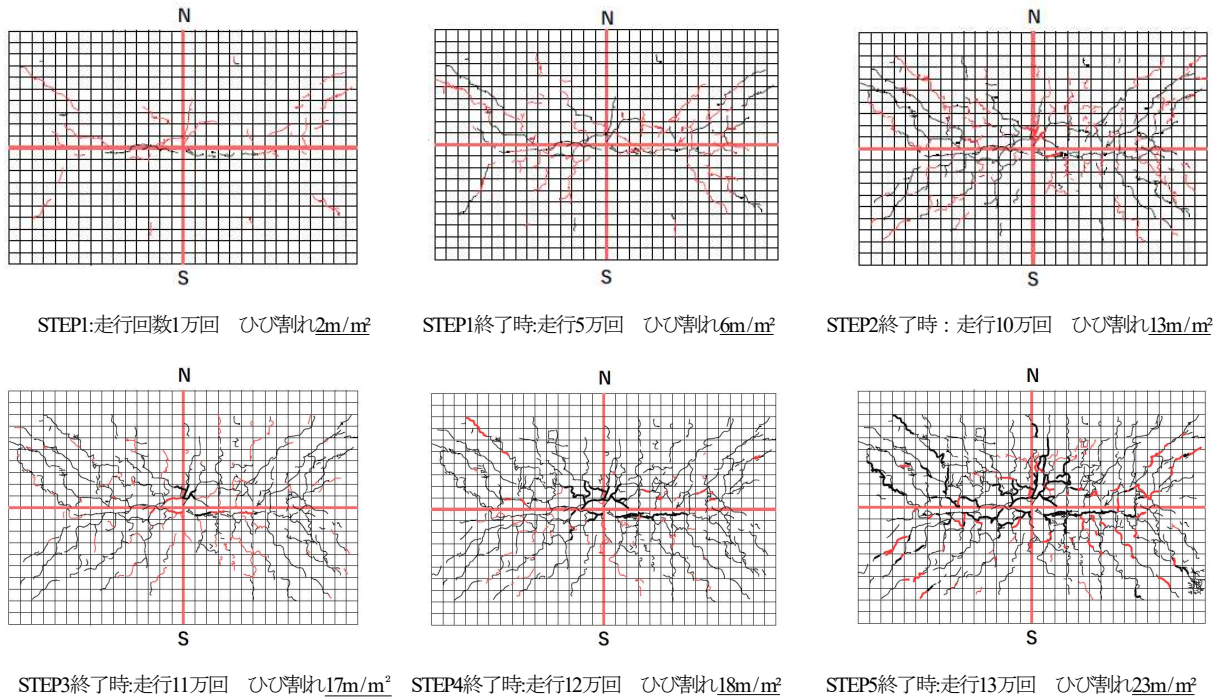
各 STEP における床版下面ひび割れ発生状況
